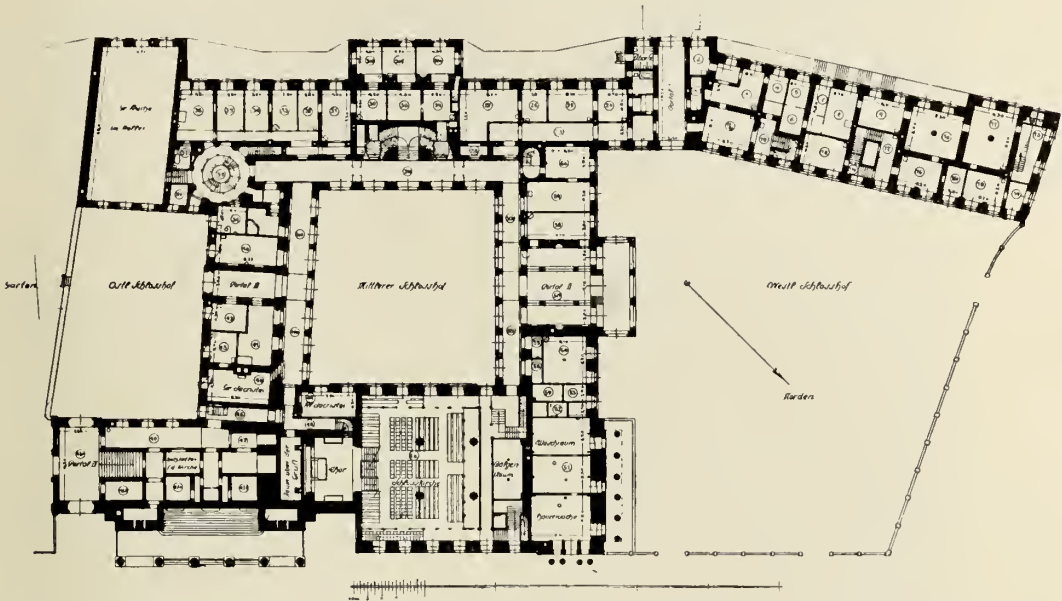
Hannover; Leineschloß, Grundriß des Erdgeschosses. Aufnahme von 1910. Stadtbauamt.
